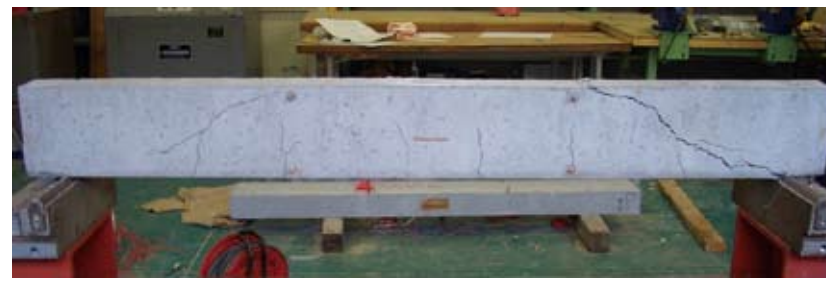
通常の梁と錨鉄筋を用いた鉄筋コンクリート梁の破壊形状
